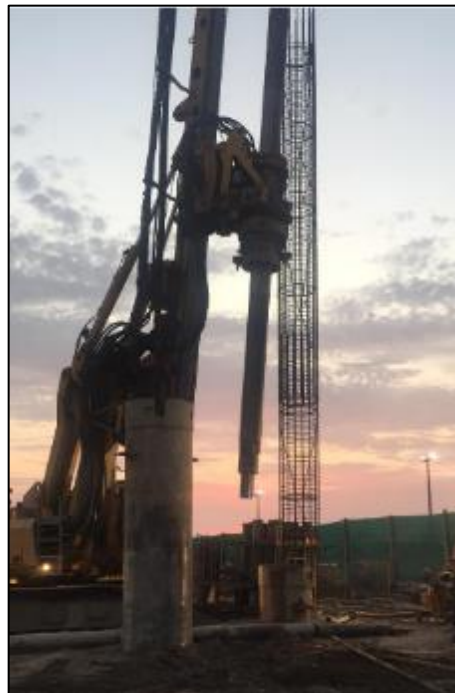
Colocación de armadura en sitio. Fecha: 03/10/2018
